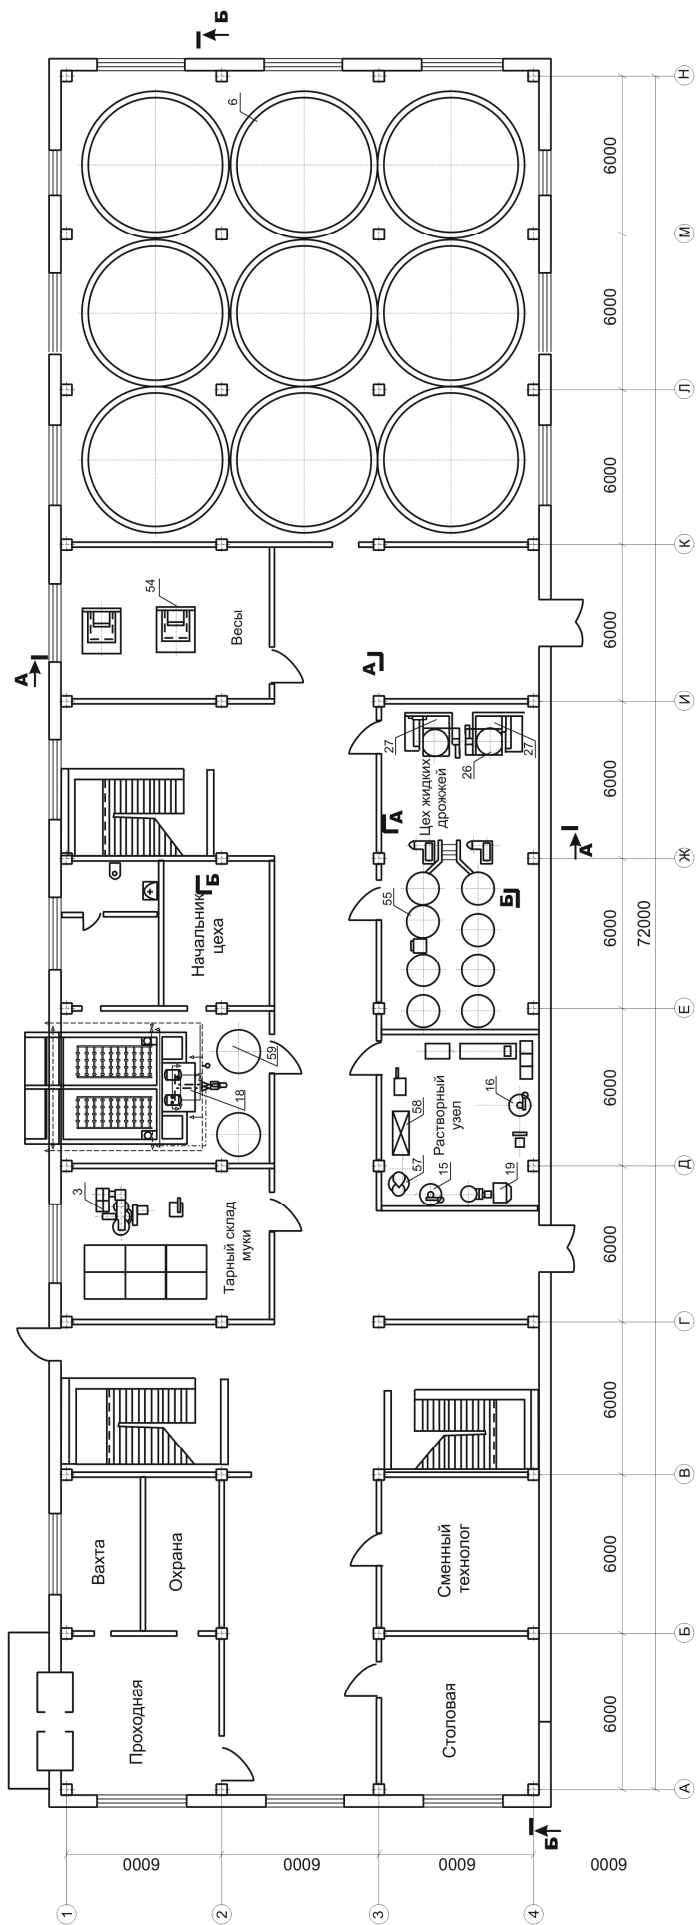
План первого этажа с компоновкой оборудования [2]
